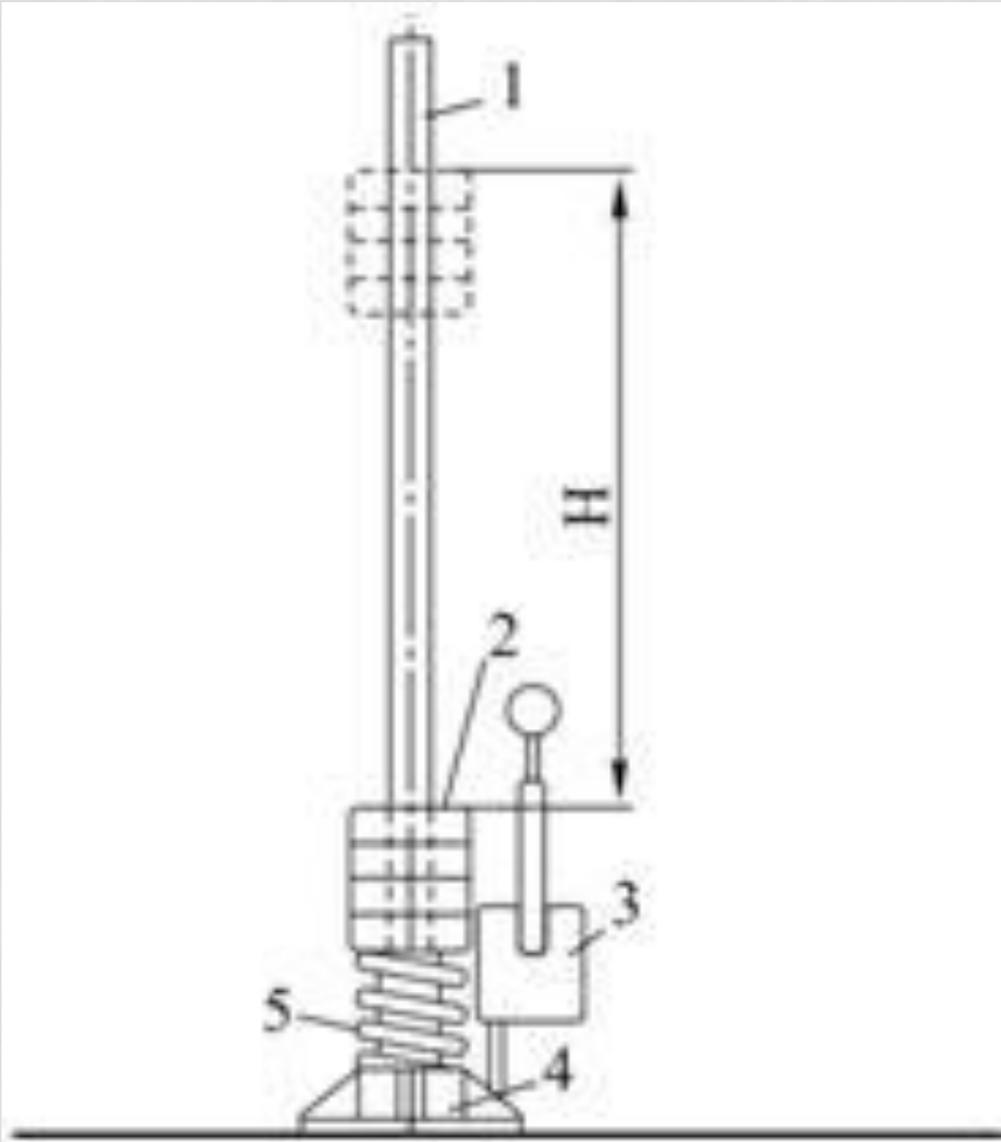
Схема проведения испытания динамическим методом:
